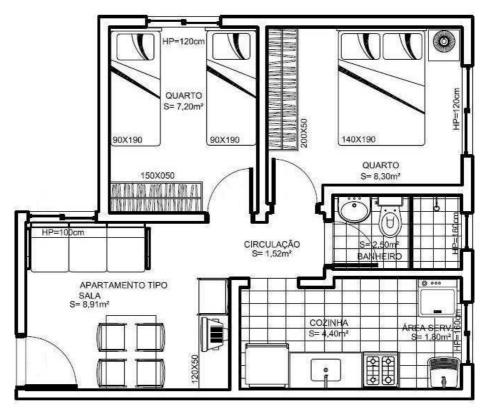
Planta baixa humanizada do apartamento tipo (sem escala)
